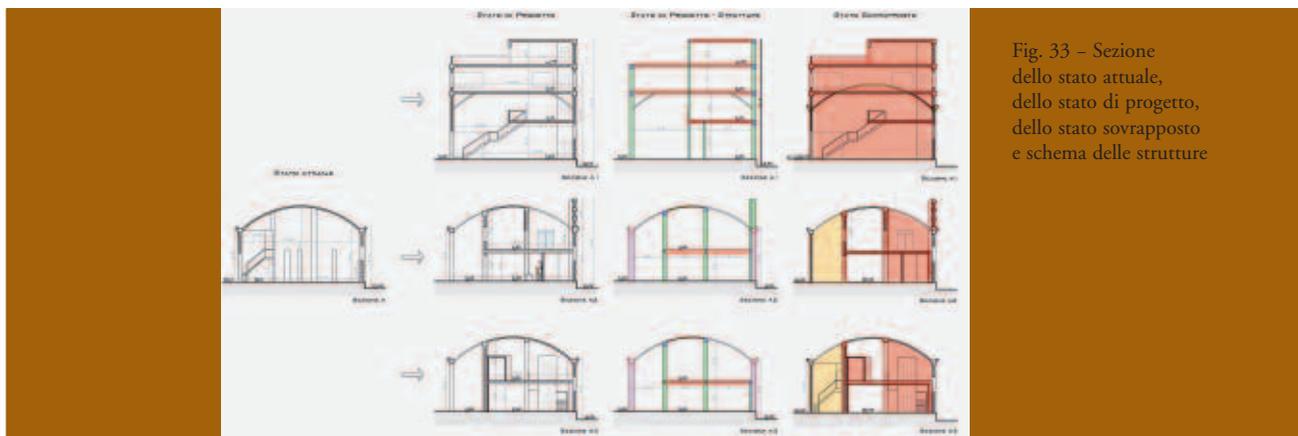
Sezione dello stato attuale, dello stato di progetto, dello stato sovrapposto e schema delle strutture
